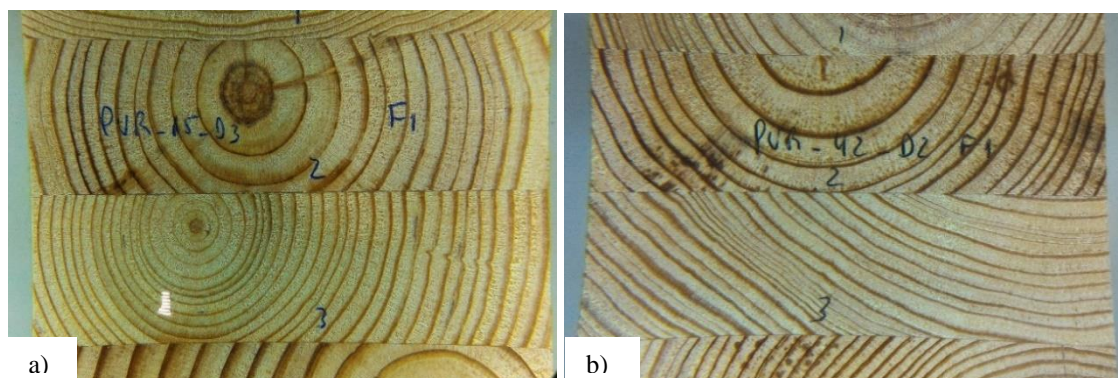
Disposição dos anéis de crescimento em provetes antes do ensaio de delaminação: a) elemento nº 15, b) elemento nº 42
